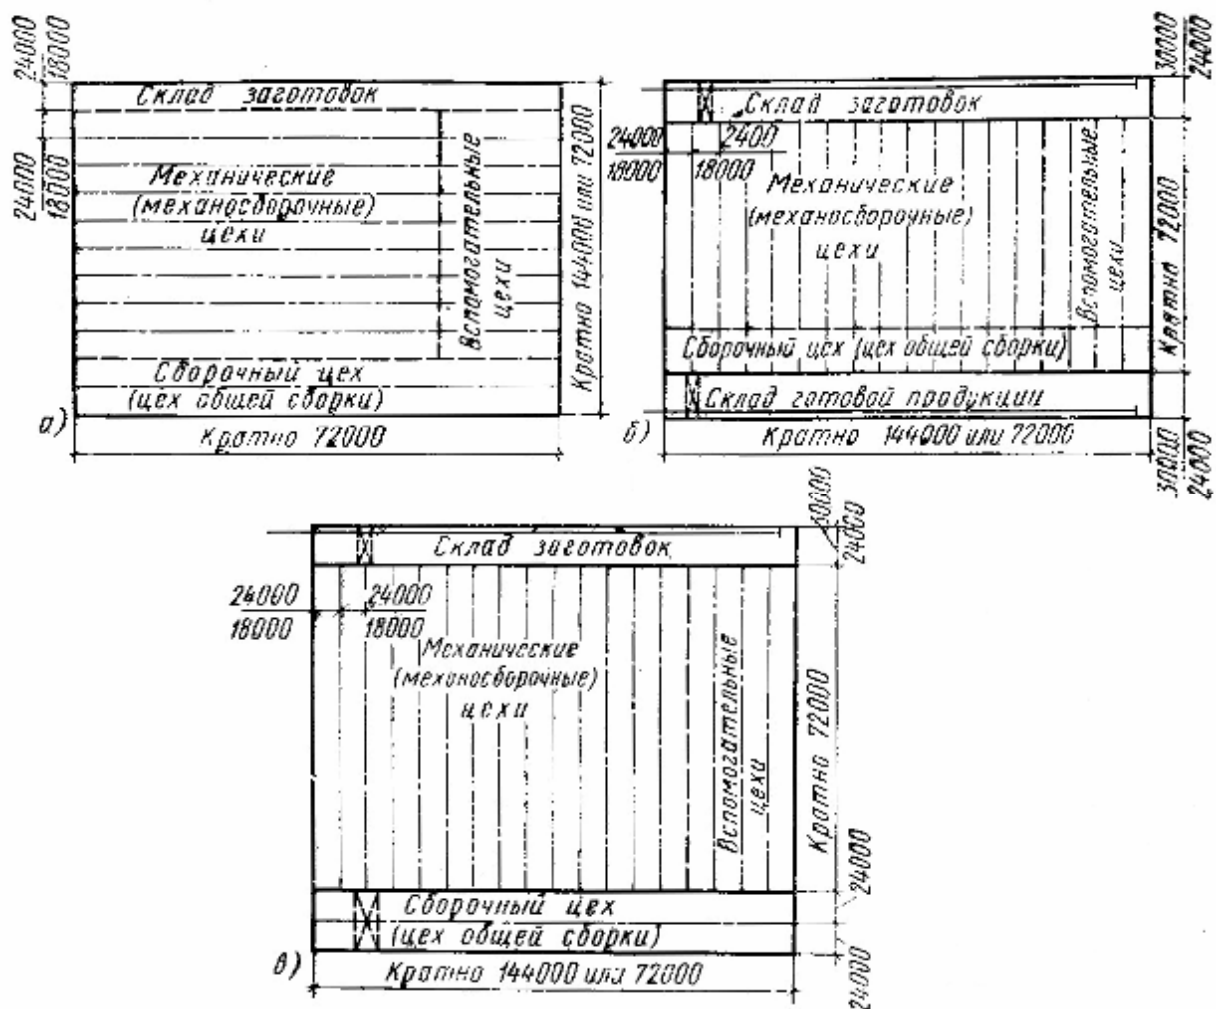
Варианты расположения нескольких цехов и складов (металла, заготовок, готовой продукции) в одном корпусе, сблокированном из унифицированных типовых секций:
